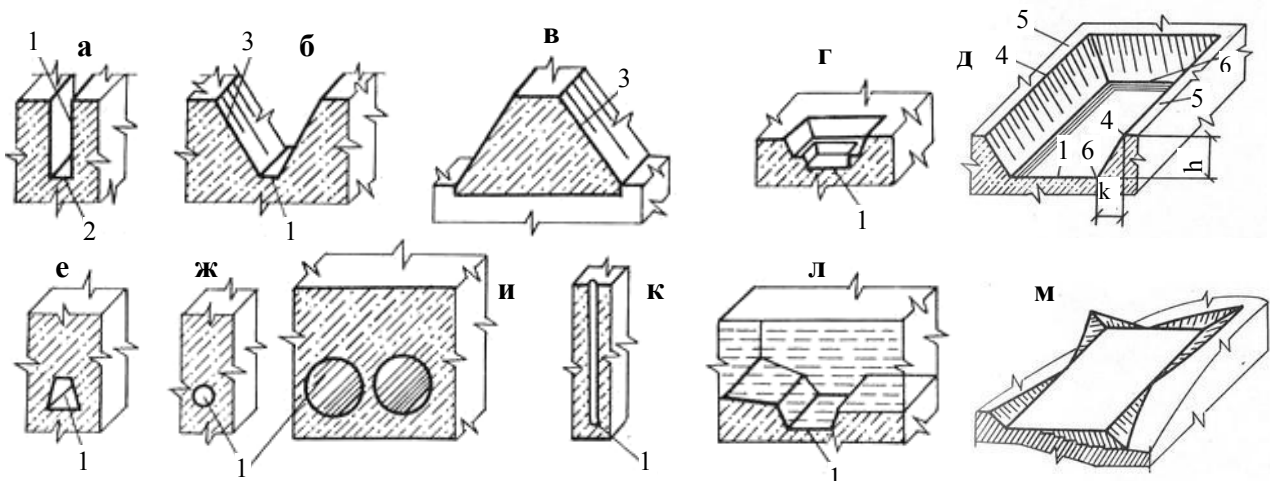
Поперечні профілі земляних споруд: а, б – траншеї з вертикальними стінами й відкосинами; в – гребля; г – котлован під фундамент; д – те саме під споруду; е – підземне вироблення під штольню; ж – те саме під каналізаційний колектор; и – те саме під тунель; к – свердловина бурова; л – траншея підводна; м – майданчик; 1 – дно; 2 – бокова стіна траншеї; 3 – бокова відкосина; 4 – брівка; 5 – берма; 6 – підшва; к – закладання відкосини; h – глибина вироблення
